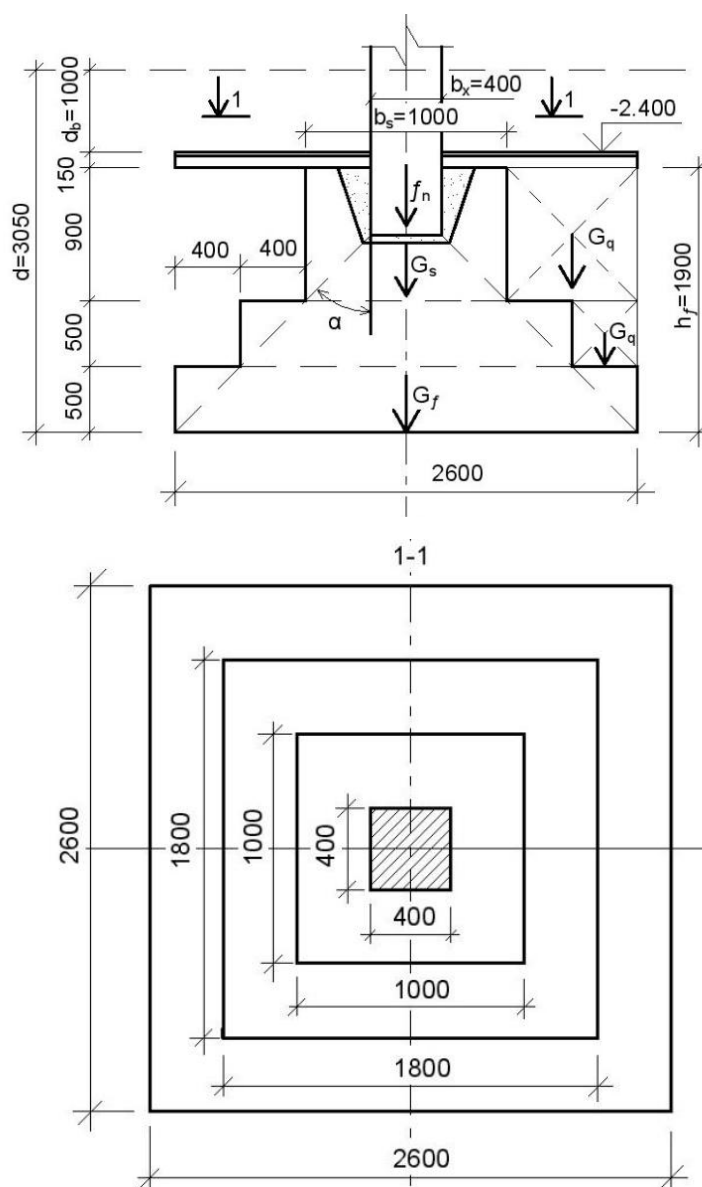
Схема монолитного железобетонного столбчатого жёсткого фундамента стаканного типа
